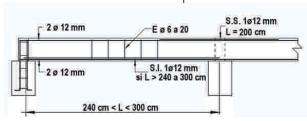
41: Plano detalle de la armadura de la viga de fundación.
